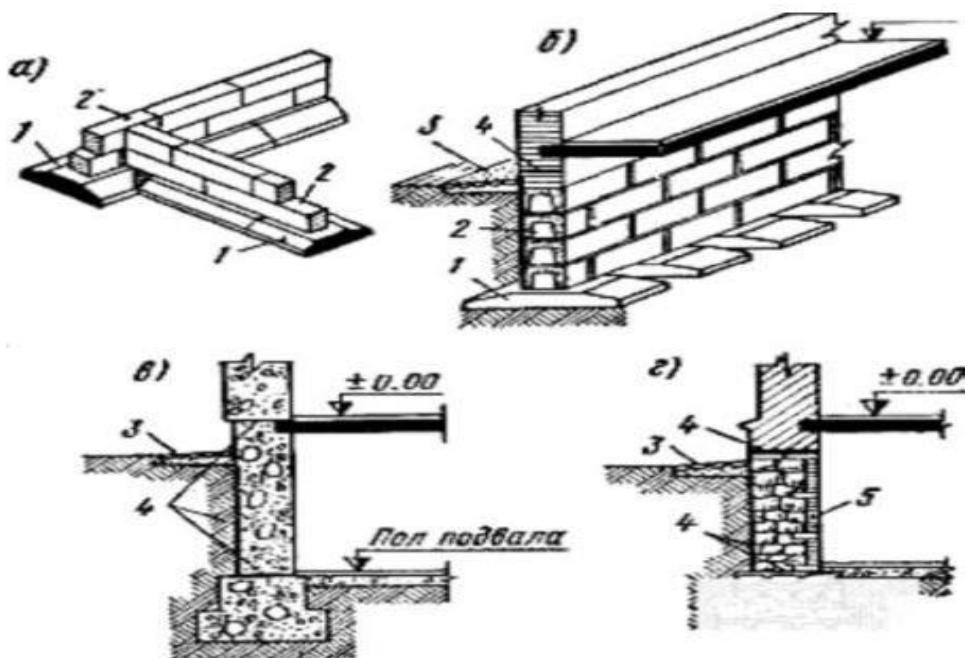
Конструкции ленточных фундаментов: а — сборный; б — то же, прерывистый; в — монолитный фундамент; г — бутовый фундамент: 1 — фундаментные подушки; 2 — бетонные блоки; 3 — отмостка; 4 — гидроизоляция; 5 — кирпичная облицовка
